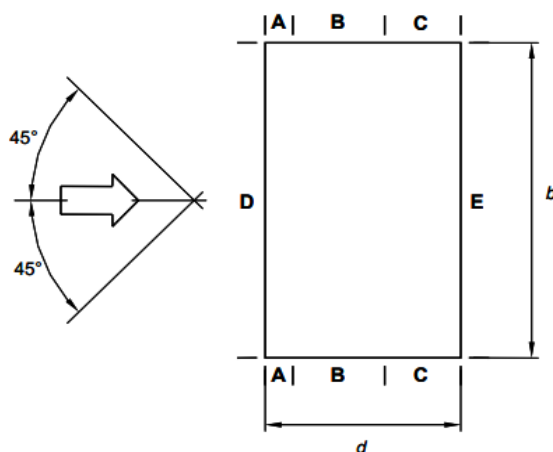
8: Suddivisione delle pareti verticali di edifici a pianta rettangolare in zone di uguale pressione (pianta).
